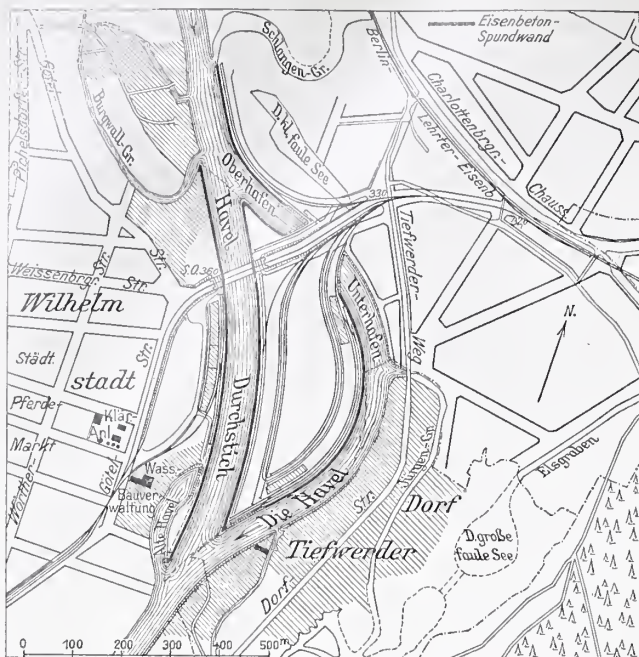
Lageplan des neuen Hafens bei Spandau.
